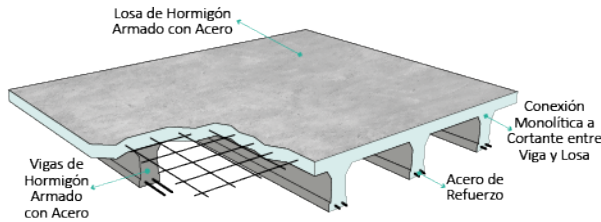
Detalle de Losa de Hormigón Armado Aligerada con Nervios en una Dirección.
